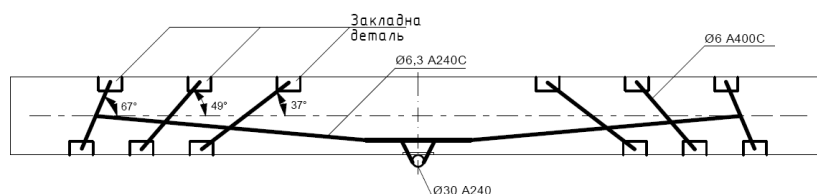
Схема підсилення балки БПС-ІІ-1 поздовжньою і поперечною похило розташованою зовнішньою арматурою
